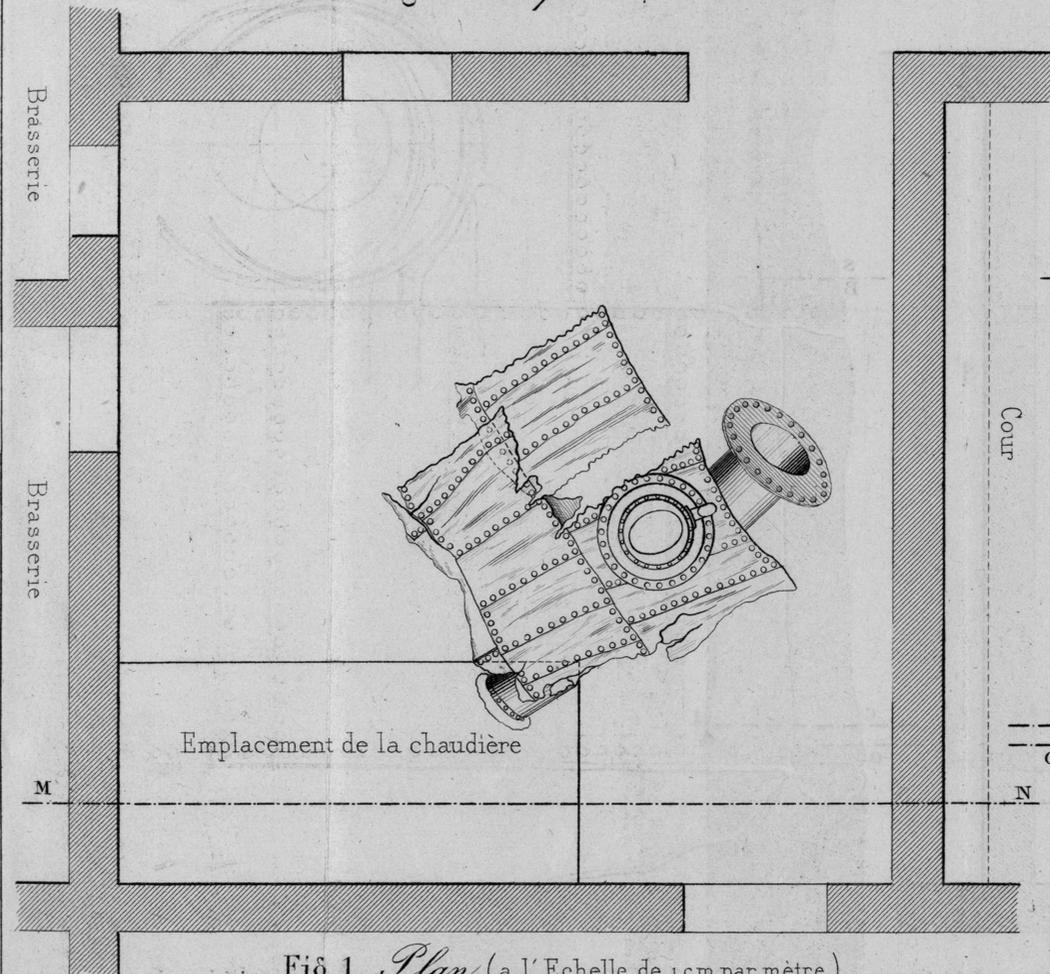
Plan (a l'Echelle de 1 cm par mètre)
